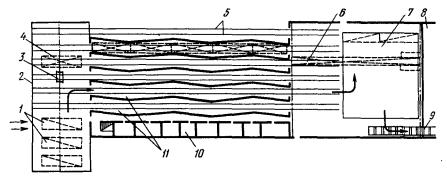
Планировка сушильного цеха с камерами непрерывного действия при системе единого пакета:
